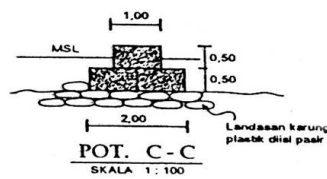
Gambar situasi krib laut tipe susunan buis beton
